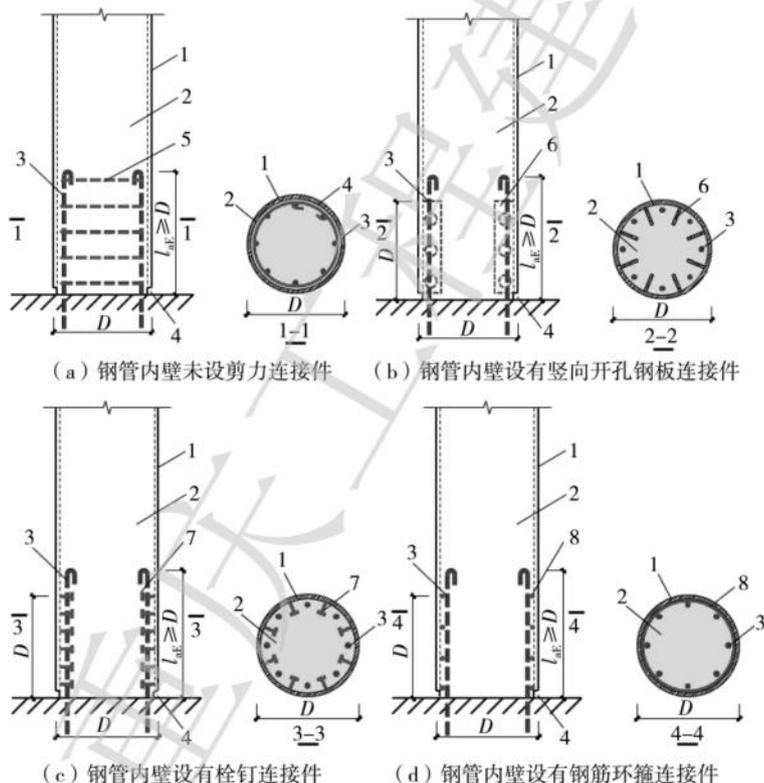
纵筋搭接锚固式柱脚构造示意
